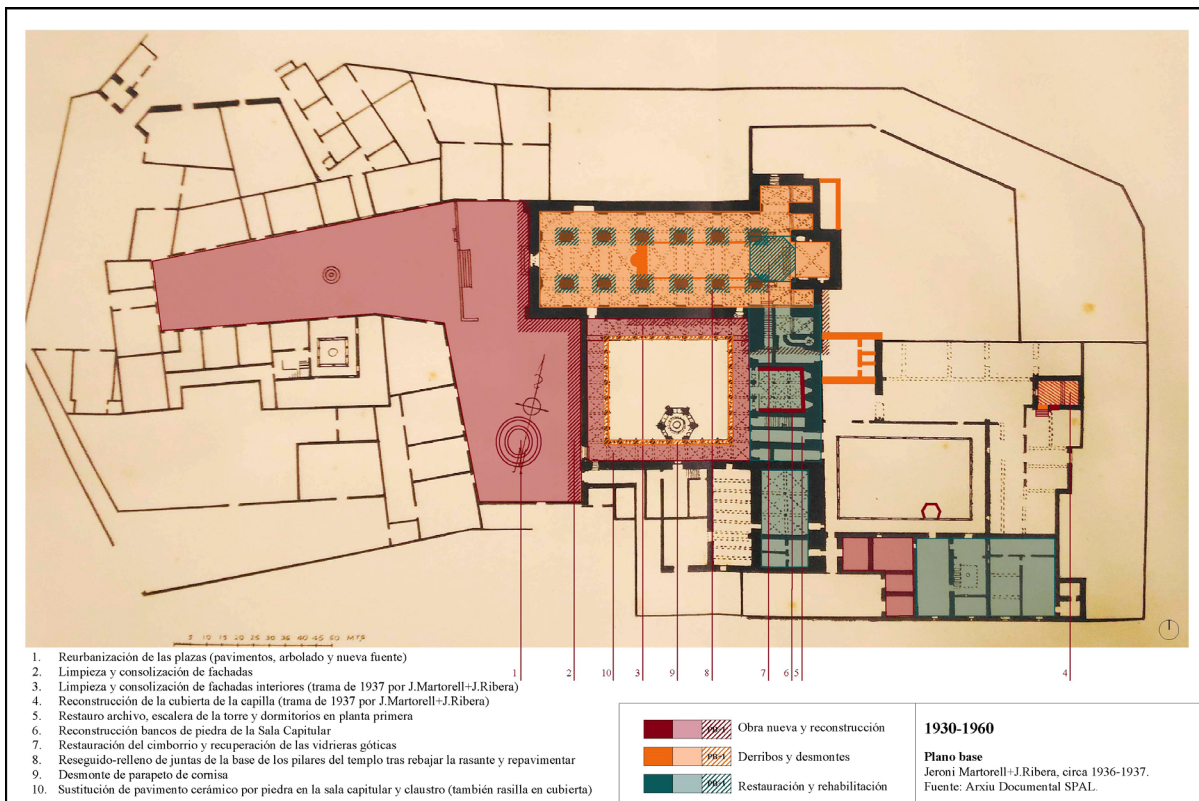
Plano dónde se recogen las intervenciones de entre 1930 y 1960. Elaboración propia.
